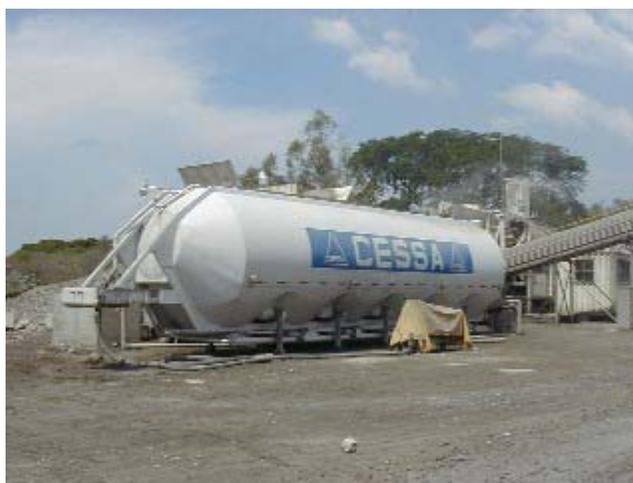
Planta Florencia, Autopista S.S-Comalapa-Aeropuerto.
